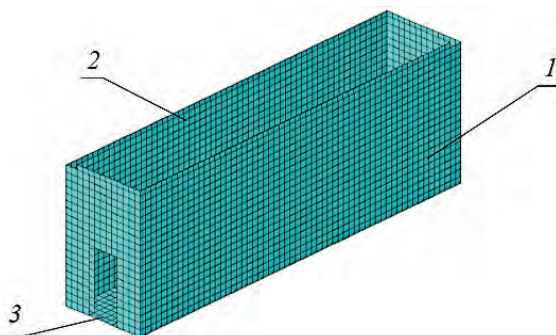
Вариант расчетной схемы экспериментальной модели с плоскими КЭ слоев стен, железобетонной плиты и основания под ней с размерами 15×15 см: 1 – КЭ лицевого слоя; 2 – КЭ внутреннего слоя; 3 – КЭ плиты
